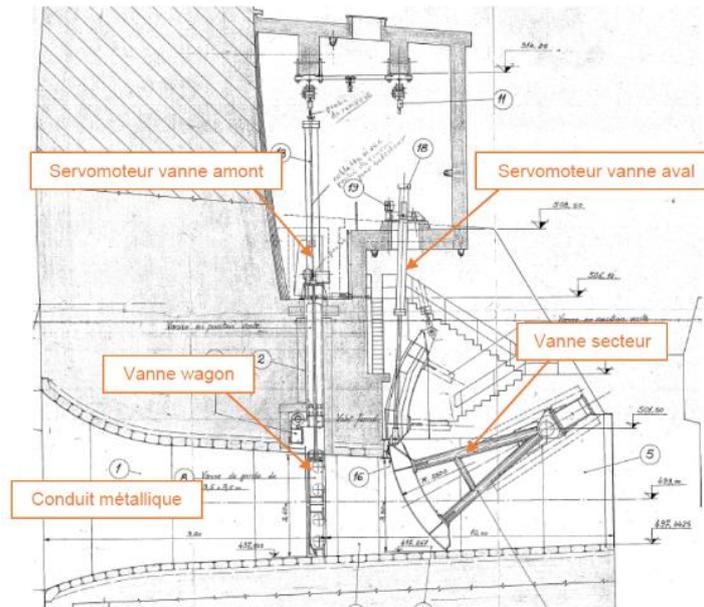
Vue en coupe d'un conduit de vidange de fond
